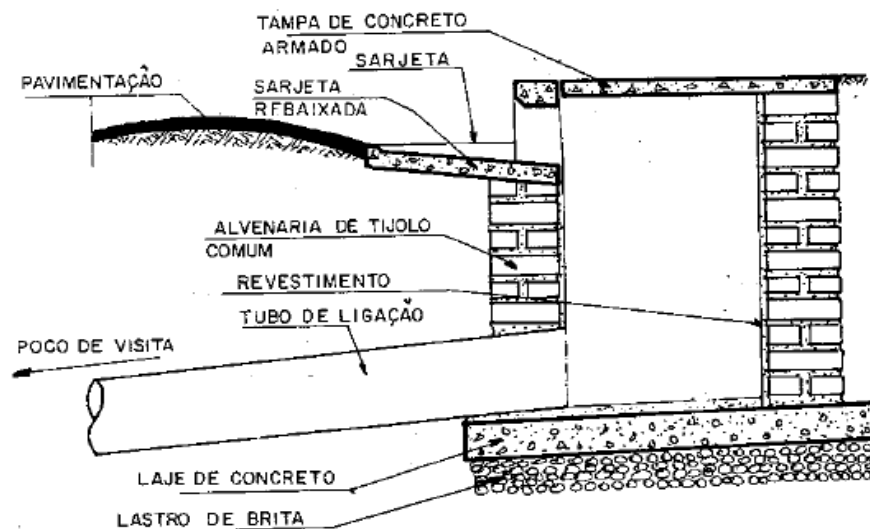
Vista transversal de um sistema de condução de água pluvial para a galeria
